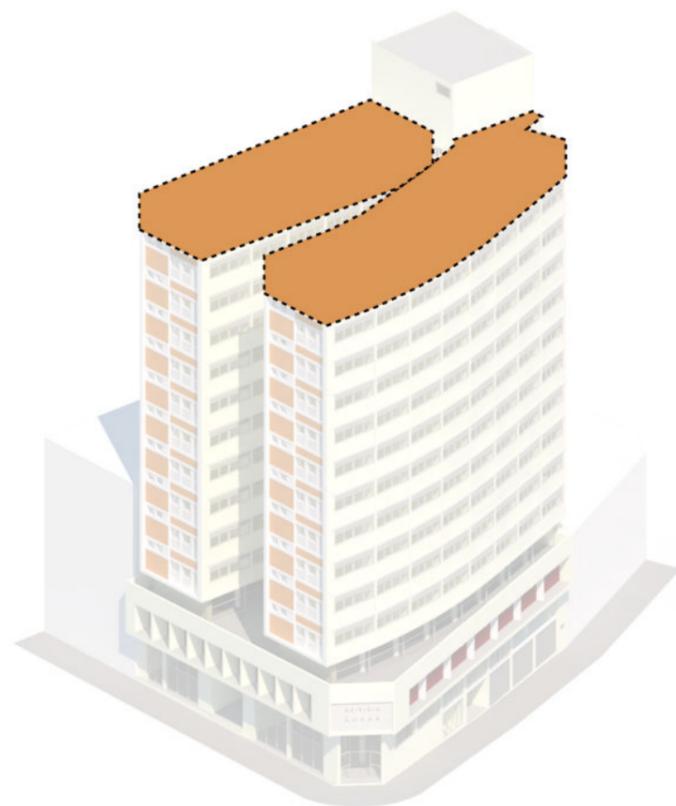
| Planta Baixa de cobertura previsto em projeto e sua esquemática de localização. Fonte: Autor (2022).
